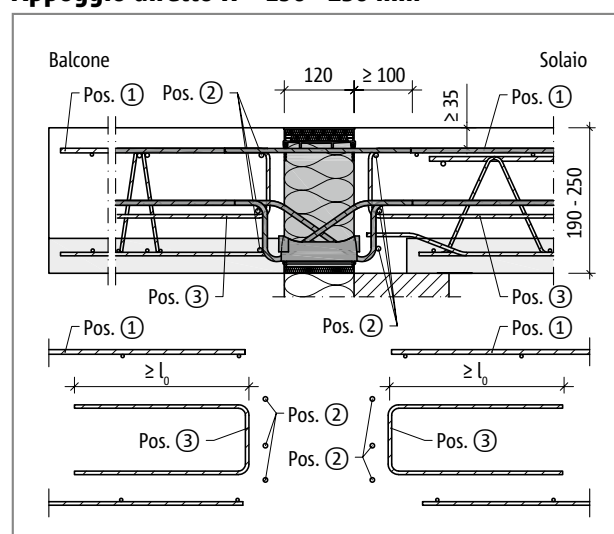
Schöck Isokorb® XT tipo KL-F-VV: armatura in opera con spessore del balcone $h = 190 - 250$ mm
